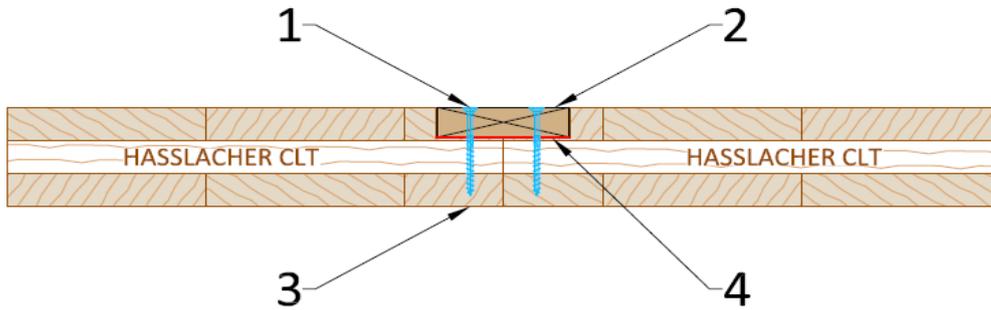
Coupe horizontale, jonction de murs, assemblage par fausse languette
